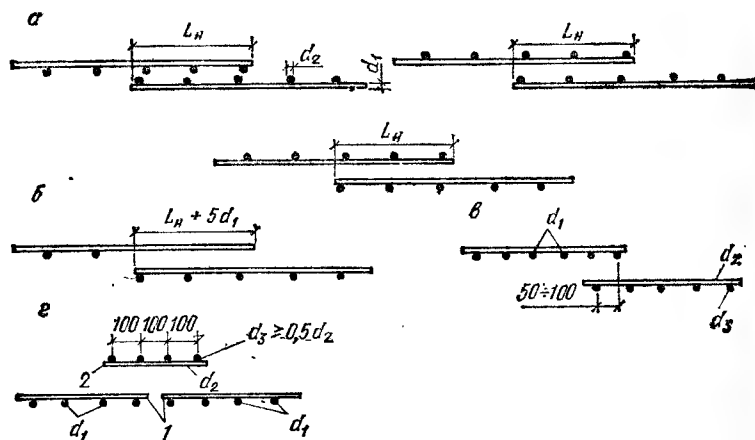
Стыки сварных сеток, выполненных внахлестку без сварки а — при гладких стержнях; б — при стержнях периодического профиля; в — в нерабочем направлении с припуском; 2 — в нерабочем направлении с дополнительной сеткой; L_n — длина нахлестки; d_1 — диаметр рабочих стержней; d_2 — диаметр распределительных стержней; d_3 — диаметр распределительных стержней распределительной сетки
